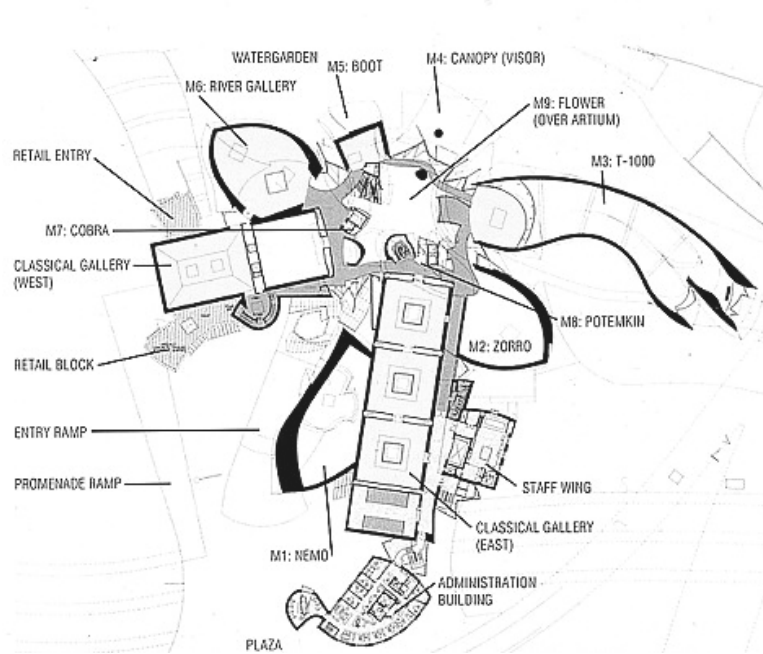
Grundriss des Guggenheim Museums, Bilbao
